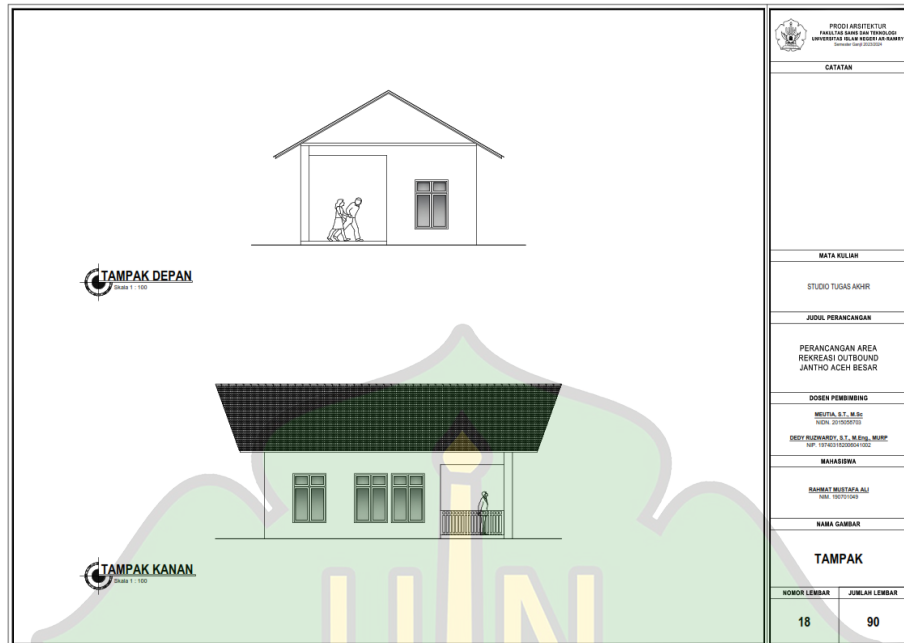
Tampak Depan Bangunan Utama
